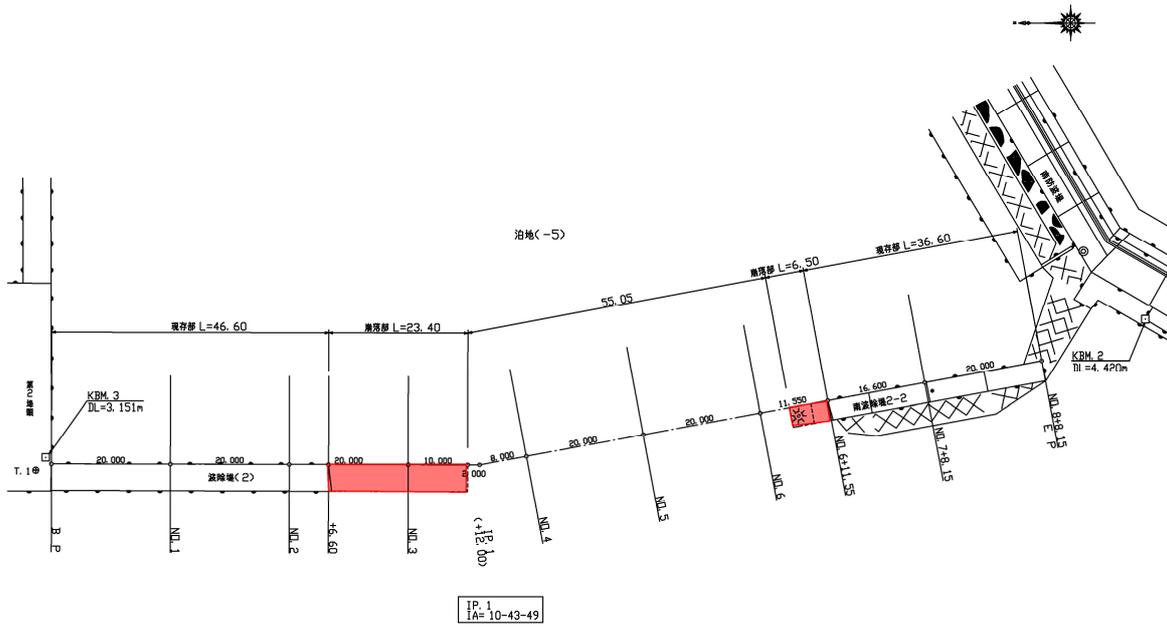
No.6 大洗港区_南波除堤の平面図 (被災後)
